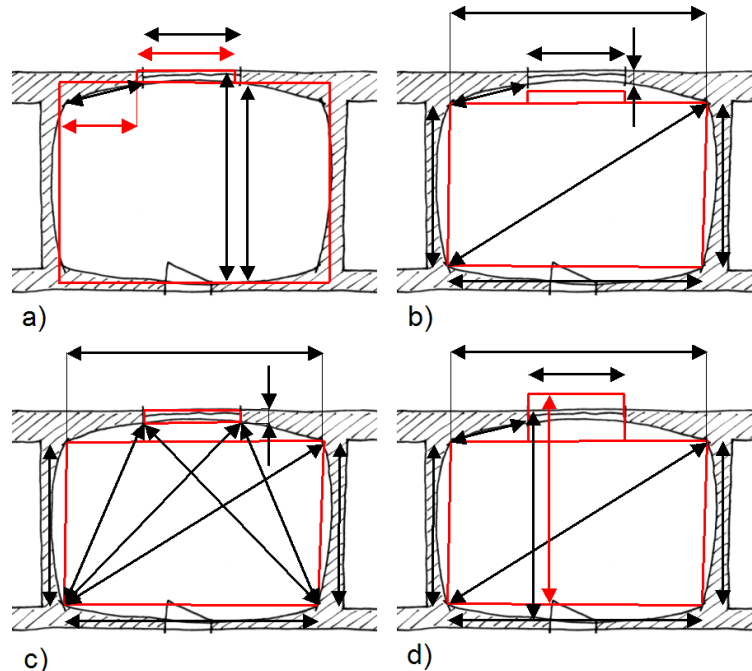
Modellierung durch Messungen am Beispiel eines Grundrisses
